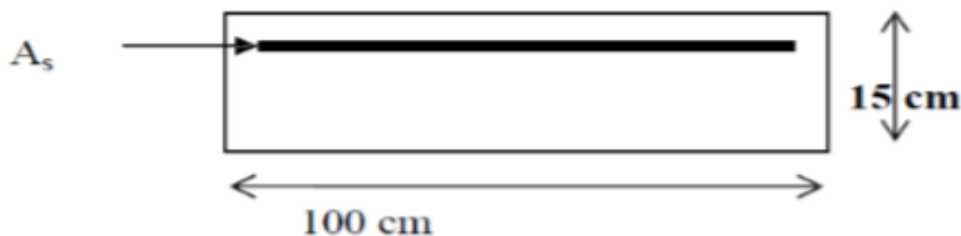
Coupe transversale d'un mètre linéaire du séchoir.
